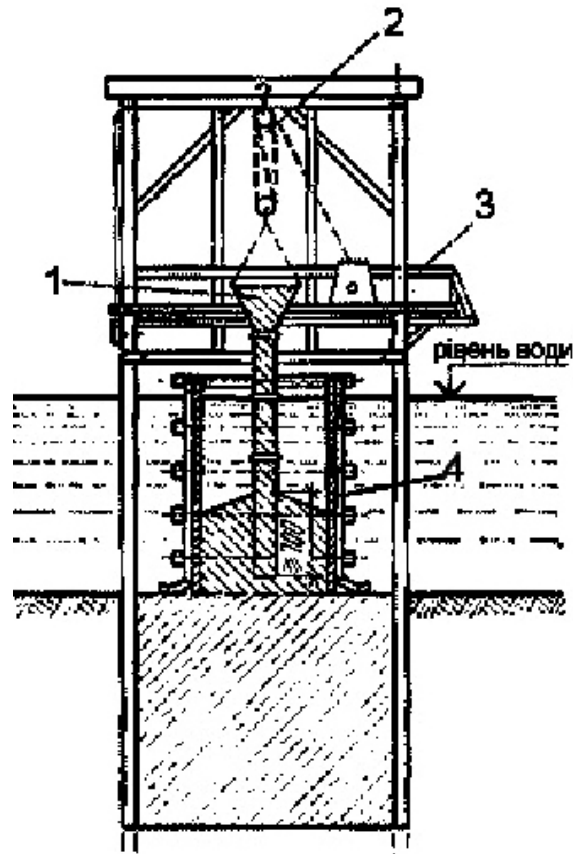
Схема підводного бетонування методом вертикального переміщення труби: 1 – труби для подачі бетонної суміші; 2 – поліспаст для підйому труби; 3 – естакада; 4 – опалубка
